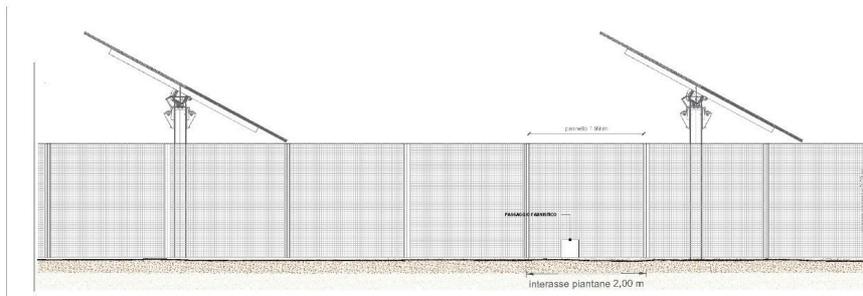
Prospetto recinzione perimetrale senza mitigazione
